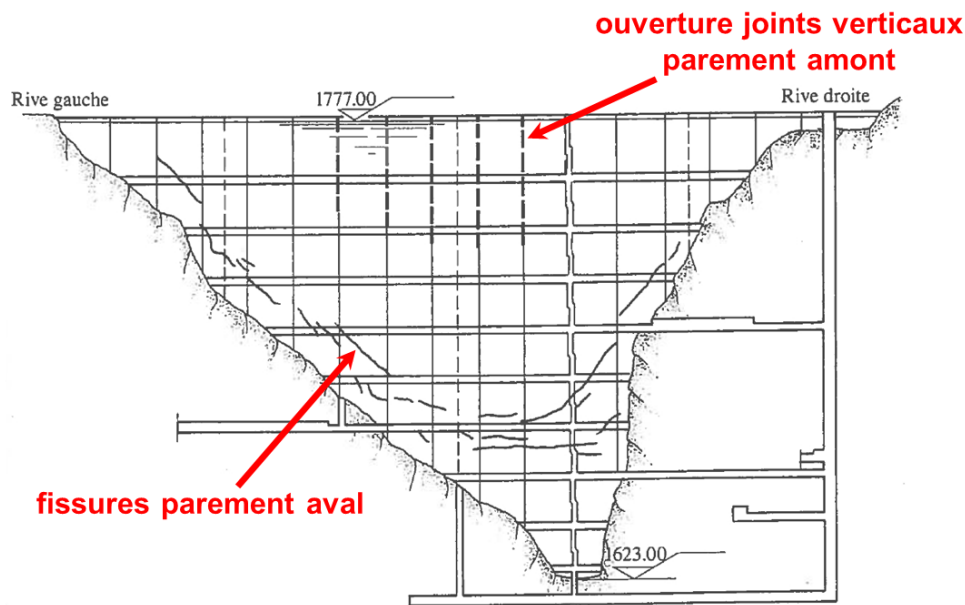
Fissure par tassement de la fondation (Zeuzier, Suisse)
